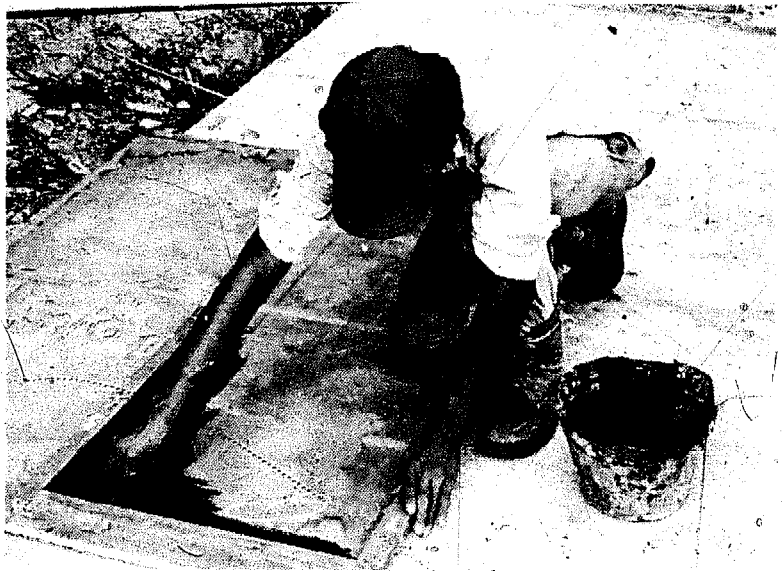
Aplicación de aceite quemado sobre la base y bordes de madera de la formaleta.
